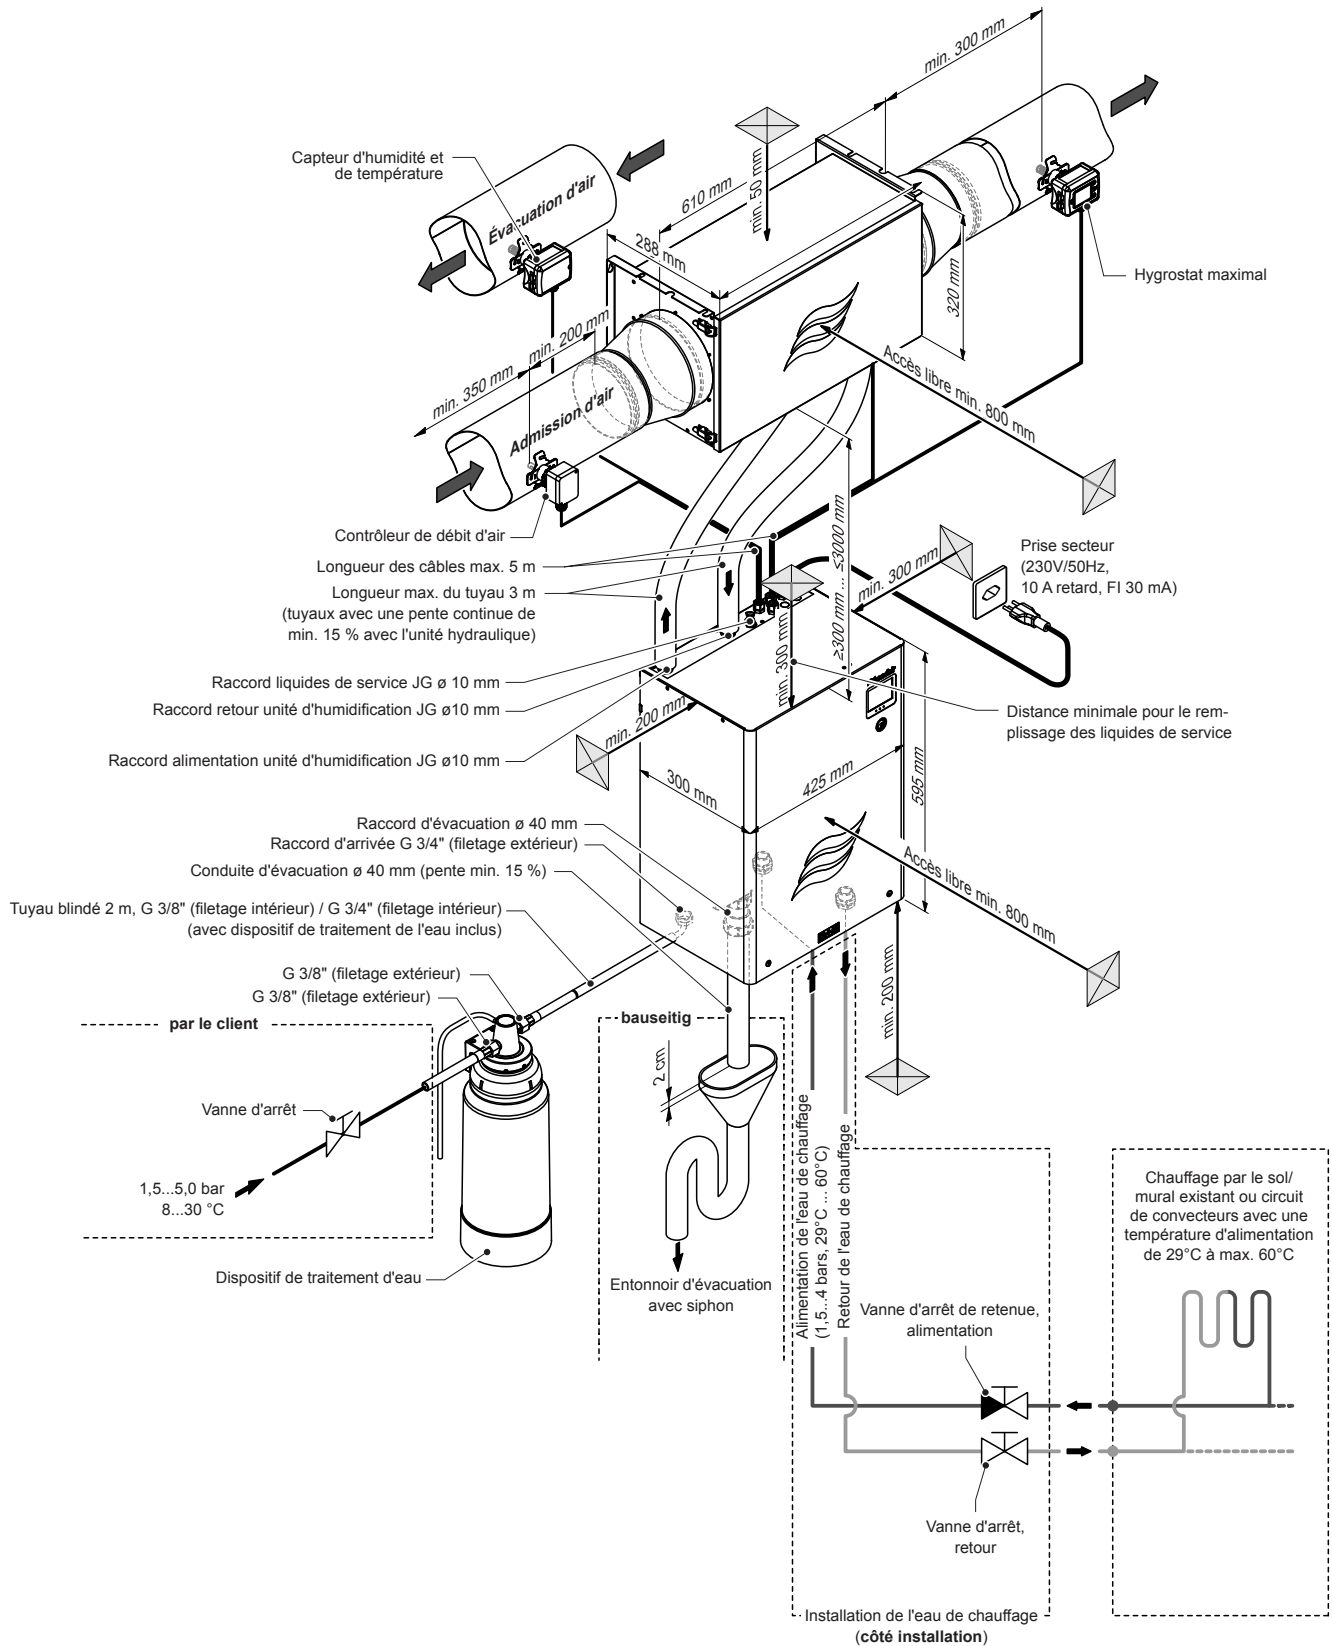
Aperçu de l'installation du Condair MD, variante MD-FB-H
